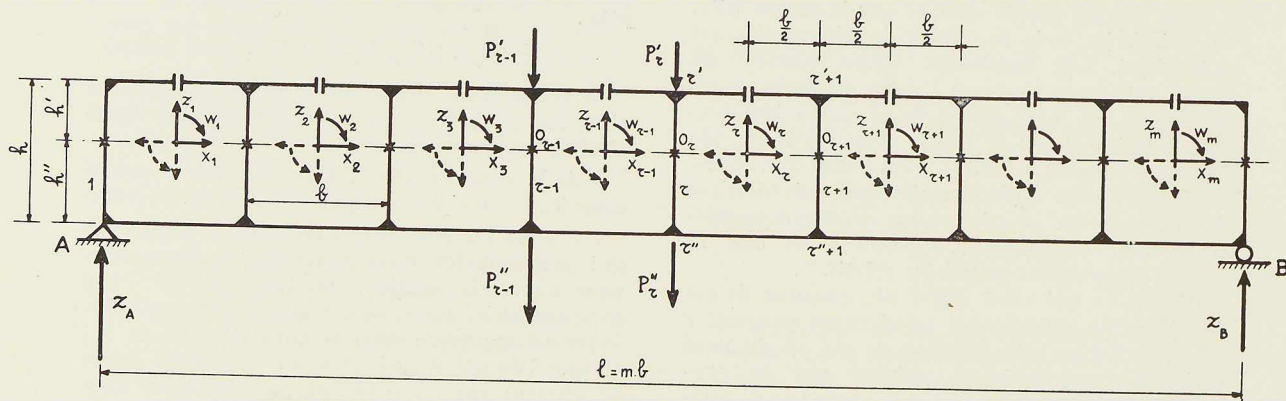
La poutre de hauteur constante, dont les points d'inflexion dans les montants sont tous au même niveau.
